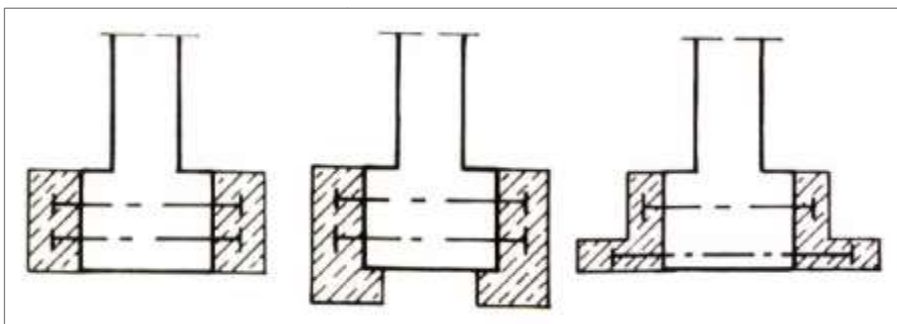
Nachträgliche Verbreiterung durch Verankerung mit Stahlbeton¹²⁶
